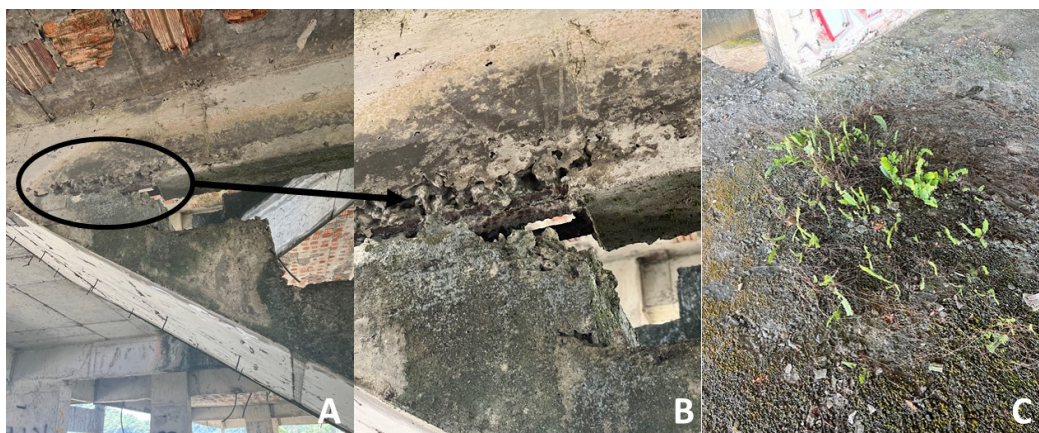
Laje de escada L51- 32: (A, B) localização; (C) musgos e plantas.
